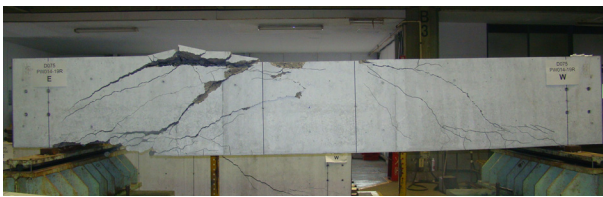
実験終了後のひびわれ状況 (D075PW014-19)
